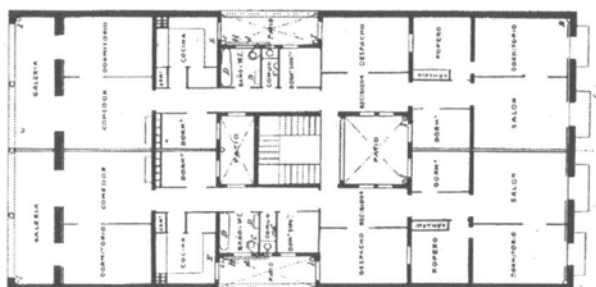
Planta tipo de un edificio de viviendas del Ensanche de Barcelona.
